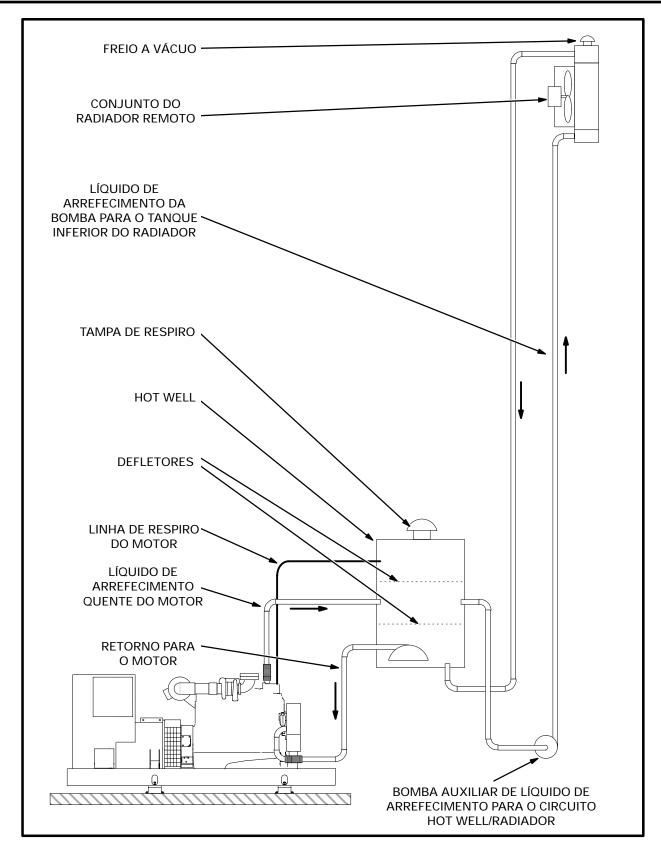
Radiador Remoto com "Hot Well" e Bomba de Arrefecimento Auxiliar
